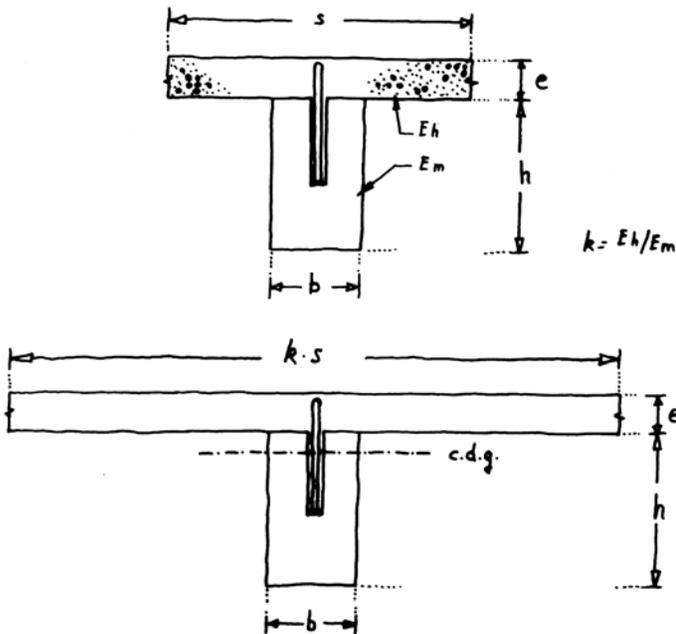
Sección mixta de madera y hormigón. Homogeneización de la sección.
